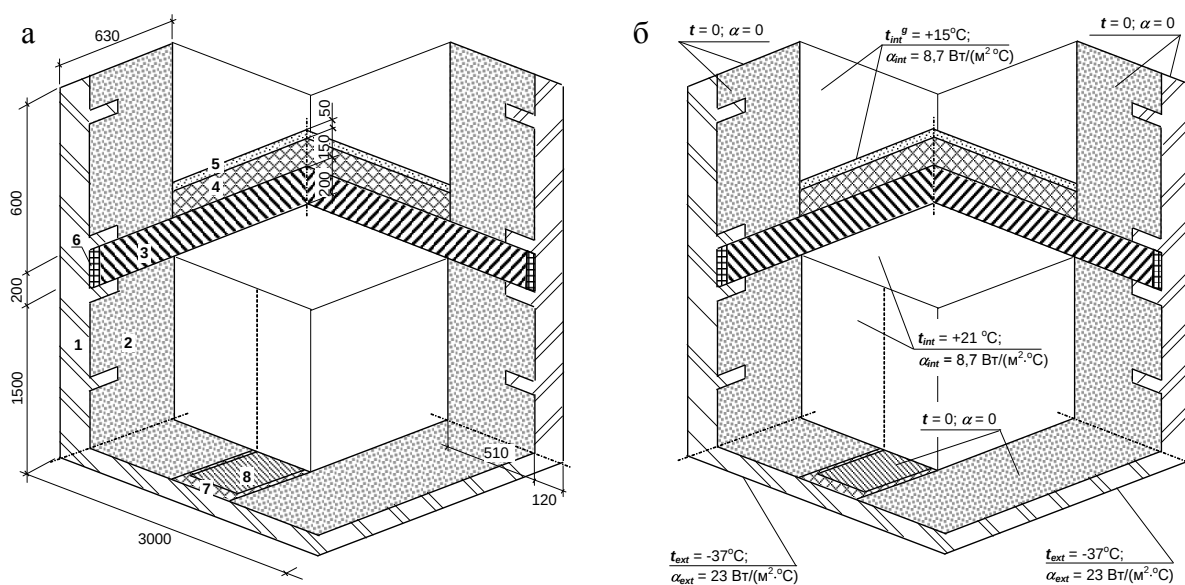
Расчетная схема (а) и схема задания граничных условий (б) узла сопряжения наружного выступающего угла с конструкцией чердачного перекрытия «теплого» чердака жилого здания: 1 – кладка из облицовочного кирпича; 2 – кладка из блоков ячеистого бетона; 3 – ж/б монолитное перекрытие; 4 – пенополистирол; 5 – цементно-песчаная стяжка; 6 – пенополистирольный вкладыш размерами 400×50×200(н) с шагом 100 мм; 7 – пенополистирольный термовкладыш на всю высоту колонны; 8 – ж/б колонна
